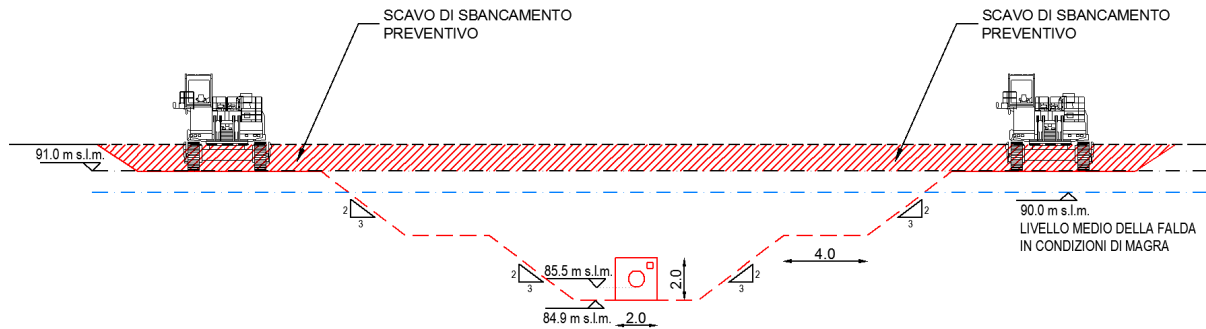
Sezione tipo di posa della tubazione mediante scavo a cielo aperto.
